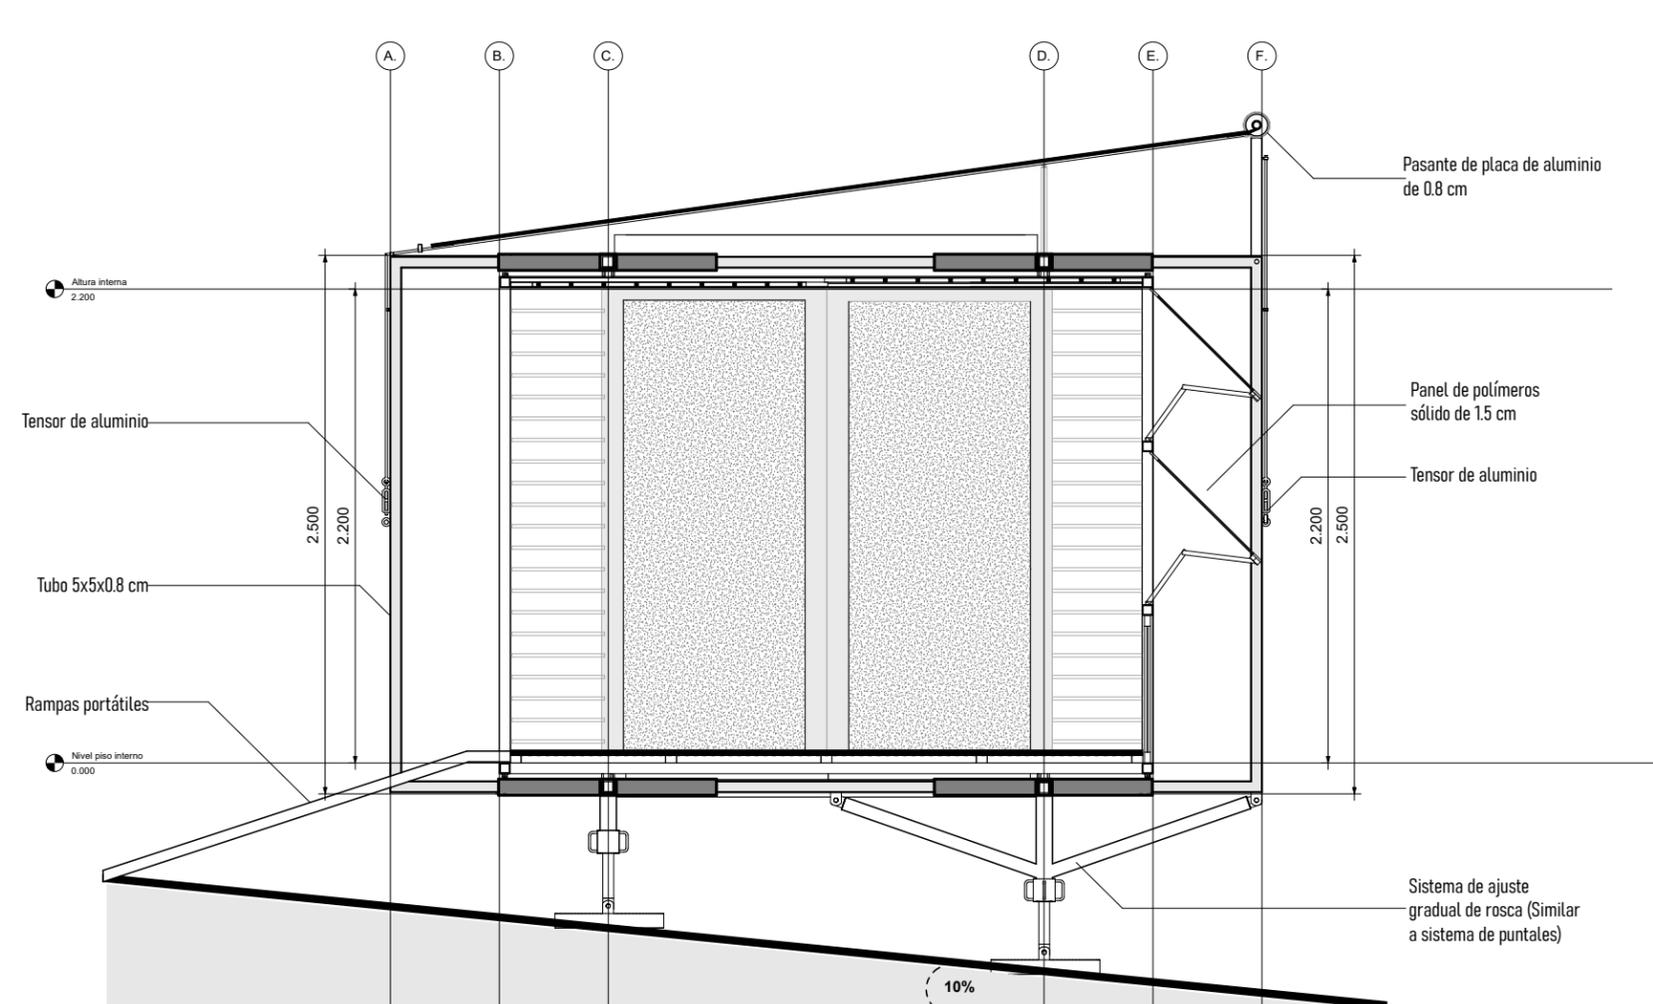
Sección A-A. Fuente: Elaboración propia.
